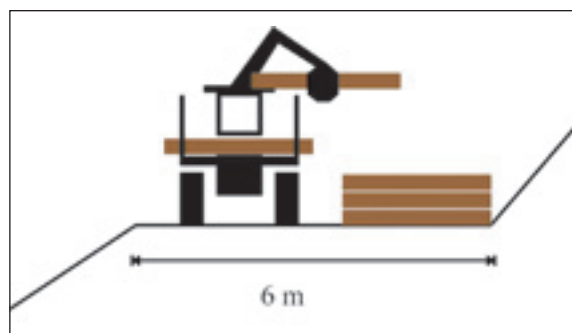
Sezione minima del piazzale per assortimenti corti (2 m) e caricamento con trattore dotato di gru idraulica.
